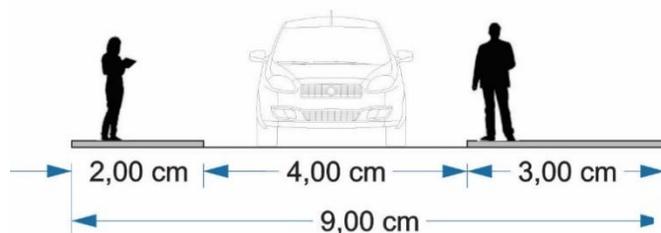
Levantamiento perfiles vialesFuente: (Elaboración propia, 2020)
